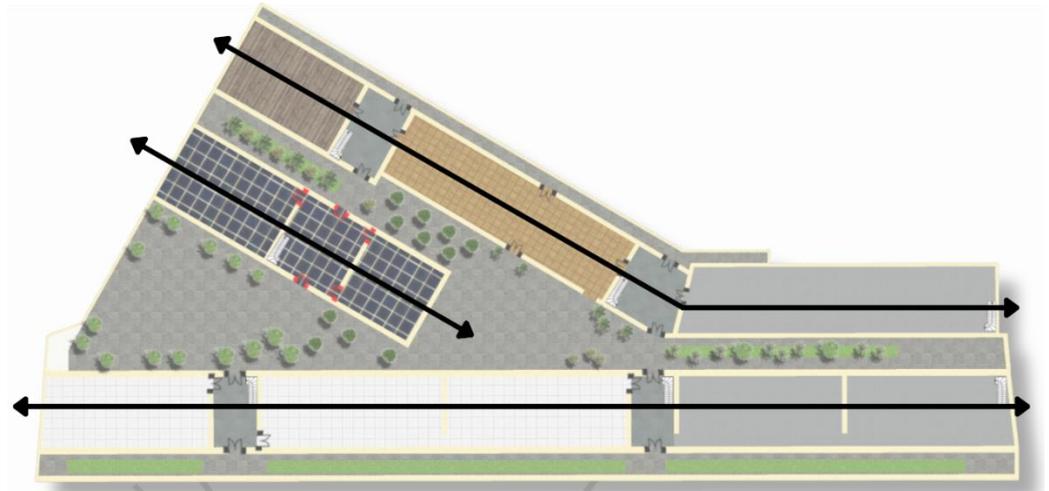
13 Bentuk Ruang Sirkulasi Lantai 2
